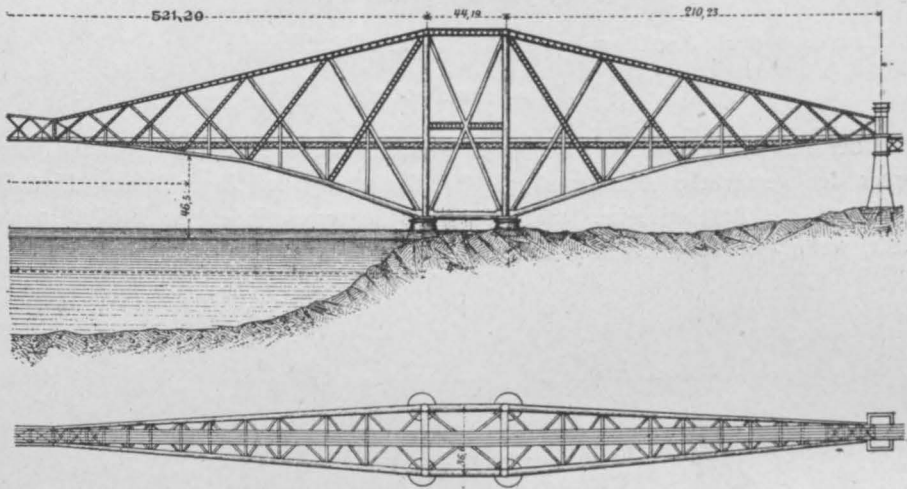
Ansicht und Grundriß einer Öffnung der Forthbrücke bei Queensferry.
